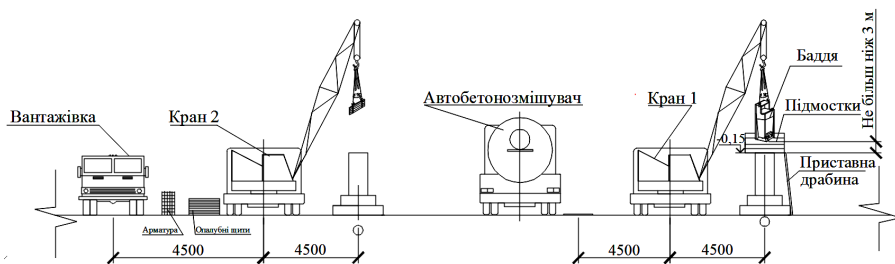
Рекомендовані схеми виконання робіт по влаштуванню конструкцій фундаментів
